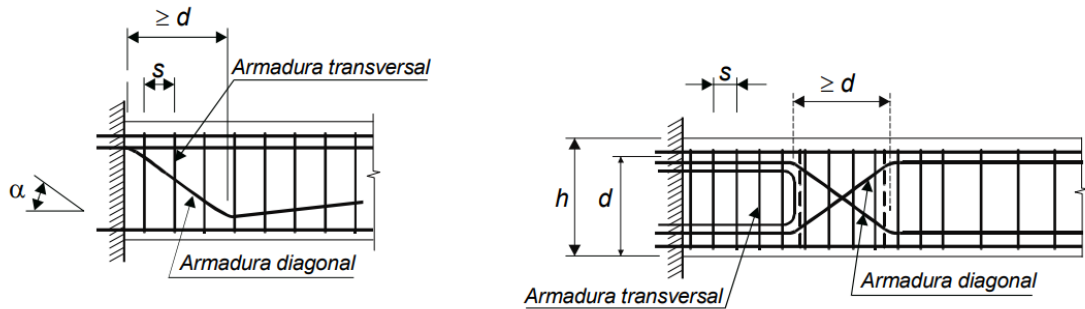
ARMADURA DIAGONAL PARA ABSORBER TENSIONES DE CORTE ELEVADAS EN ZONAS DE RÓTULAS PLÁSTICAS.
